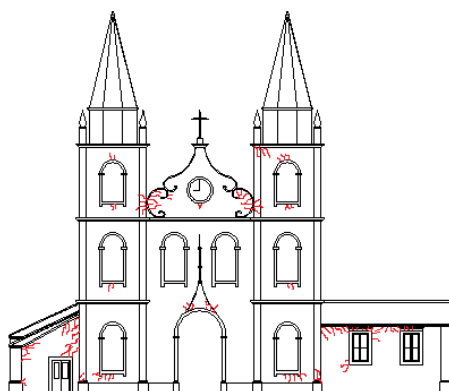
Alçado frontal com padrão de fissuração da fachada principal e sacristias em anexo.
